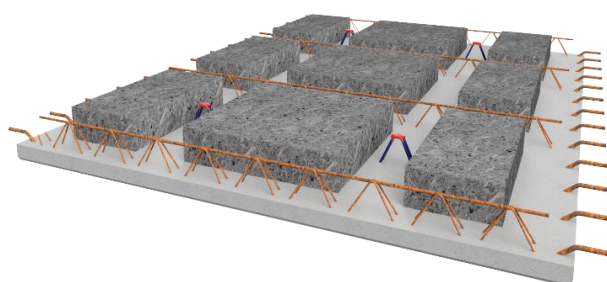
ML1 - Dalle WOODlite courante – cas béton de bois
